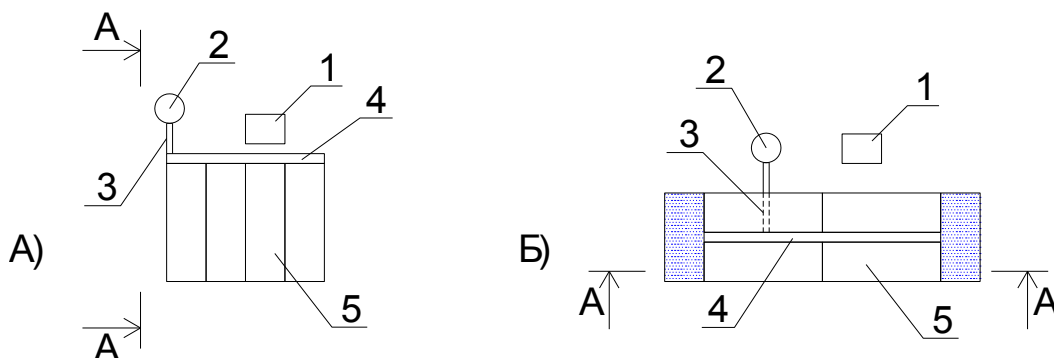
Оснащение строительной площадки контейнерами для строительного и бытового мусора.
